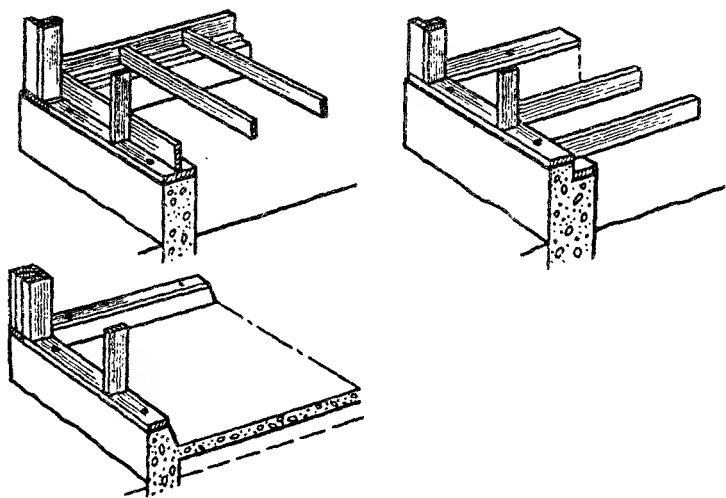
Варианты обвязки каркаса панельной сауны и ее связь с фундаментом
